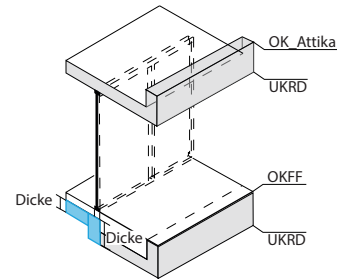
Geschossdecke, Deckenversprung, Balkon<sup>18</sup>
